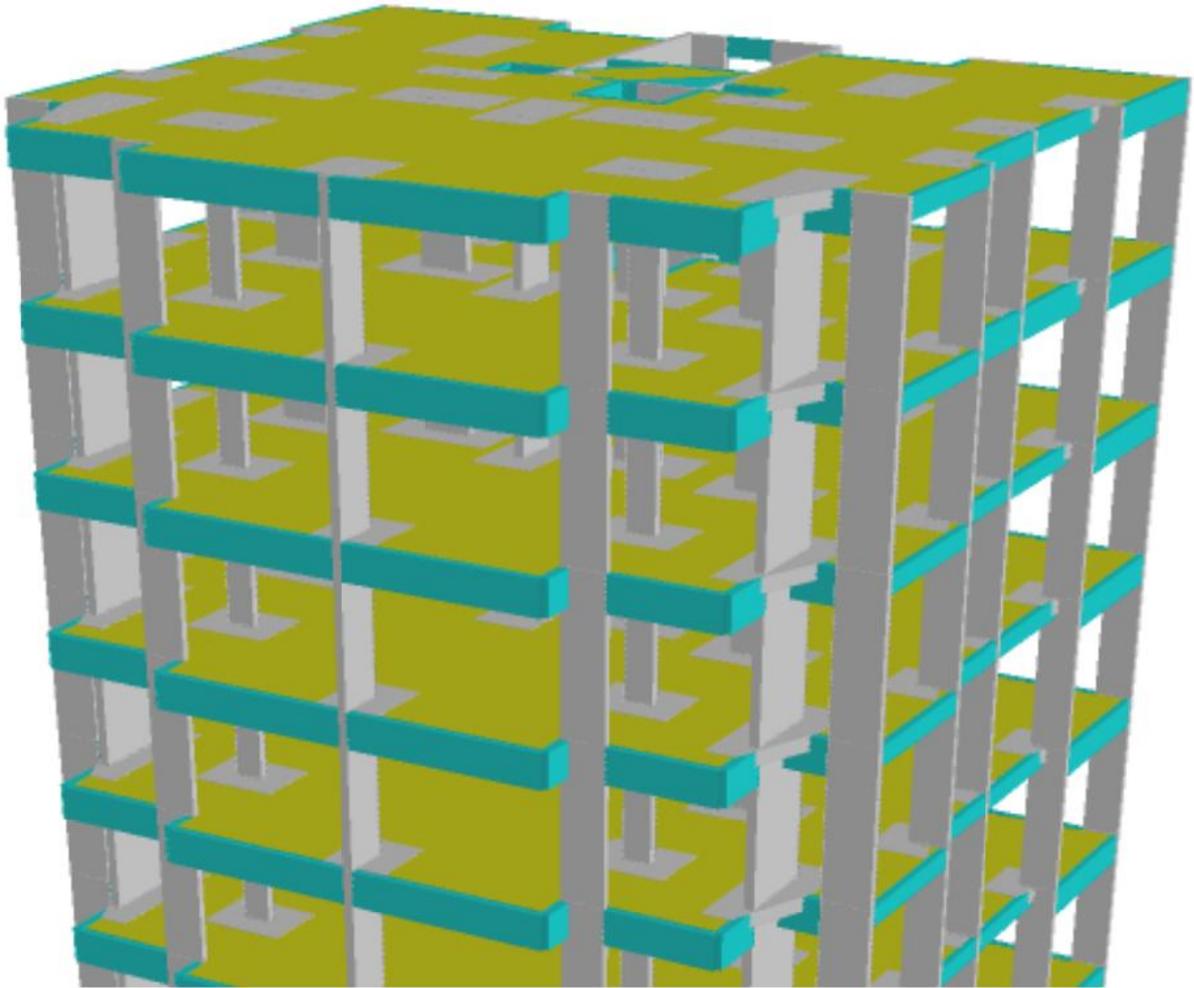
3D do Sistema Estrutural com laje nervurada.
